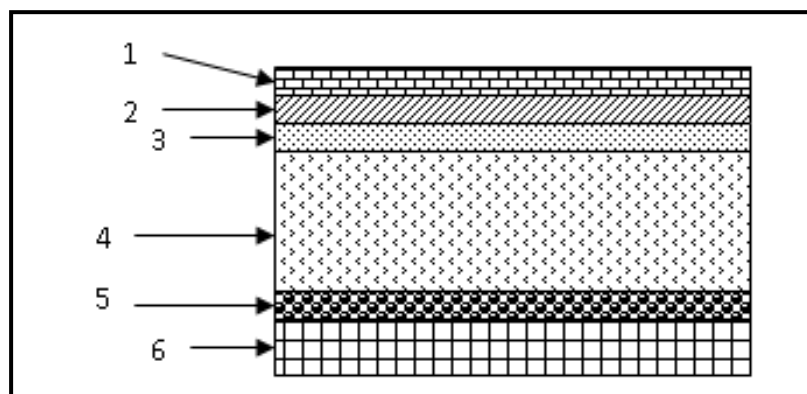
matériaux constituant du plancher étage courant en corps creux
